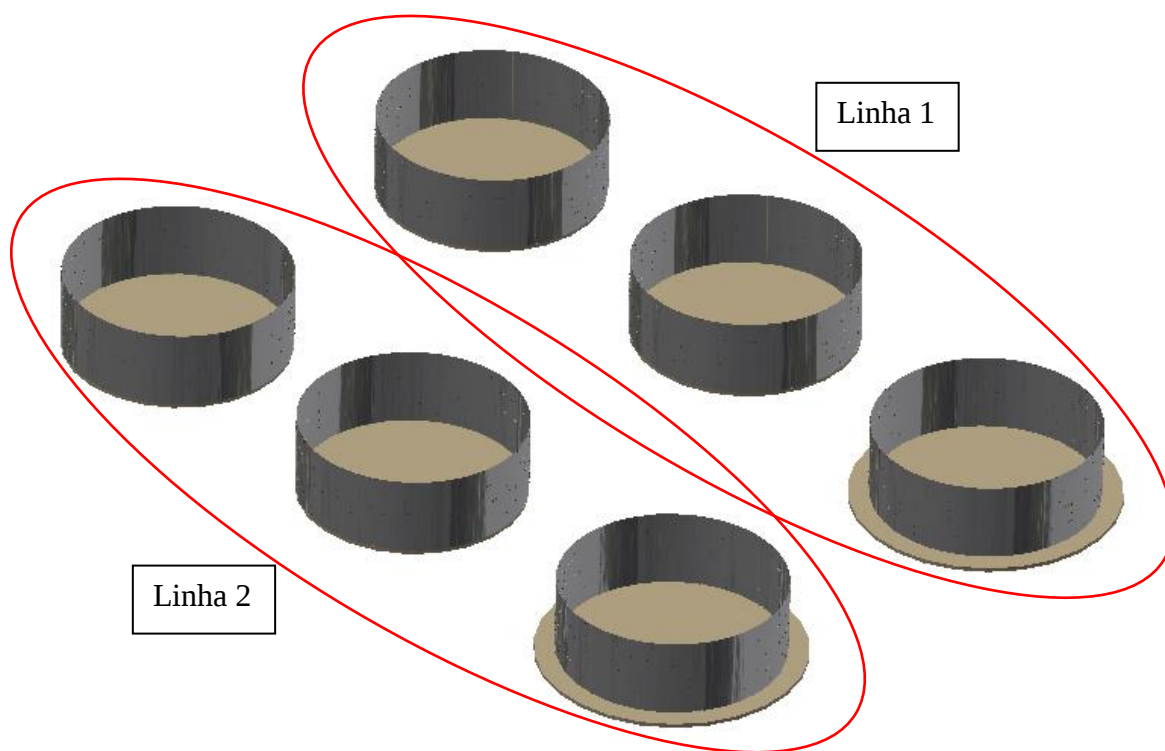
Instalação de linhas de biorreatores e tanques no projeto proposto para a planta de biogás.
